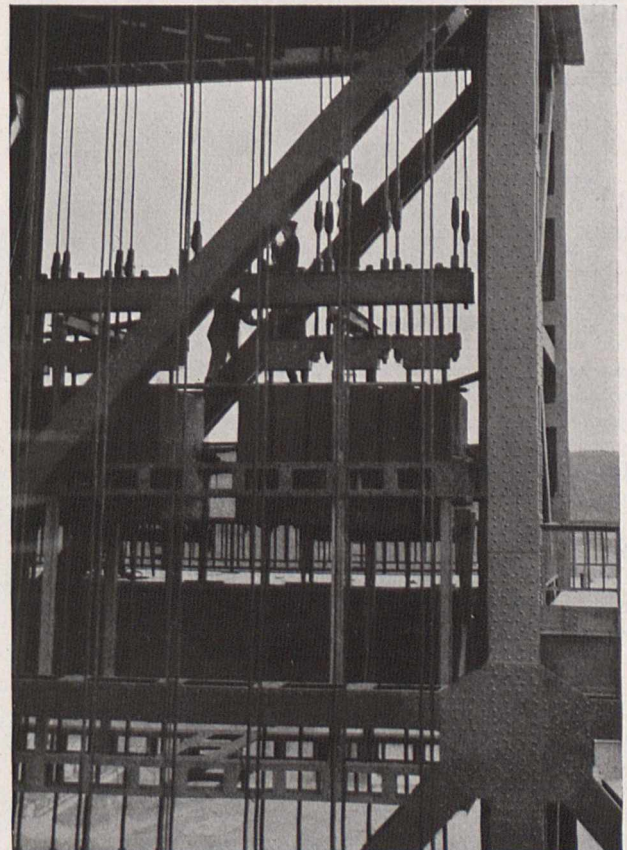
Diese gewaltigen Gewichte sind die Gegengewichte für den mehrere tausend Tonnen schweren Schiffsfahrstuhl
